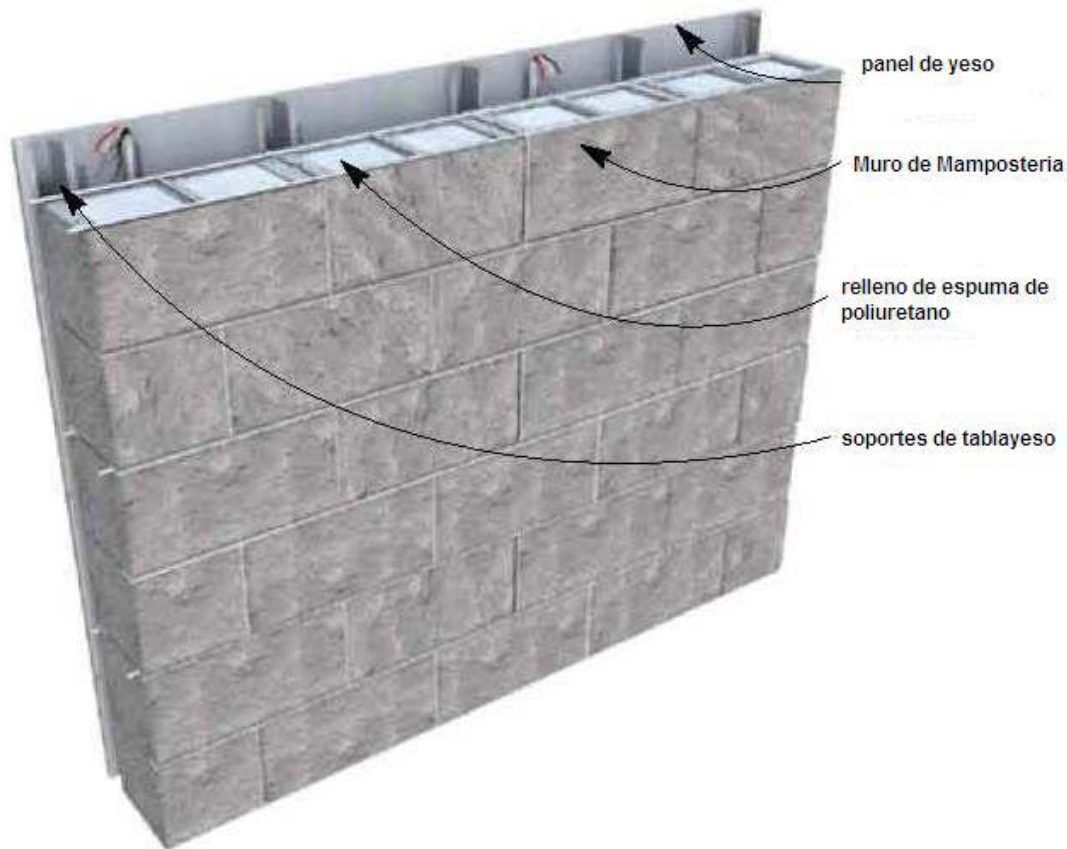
, aislamiento de muro de mampostería con uso de paneles de yeso, tomado de NCMA, thermal catalog of concrete masonry assemblies
